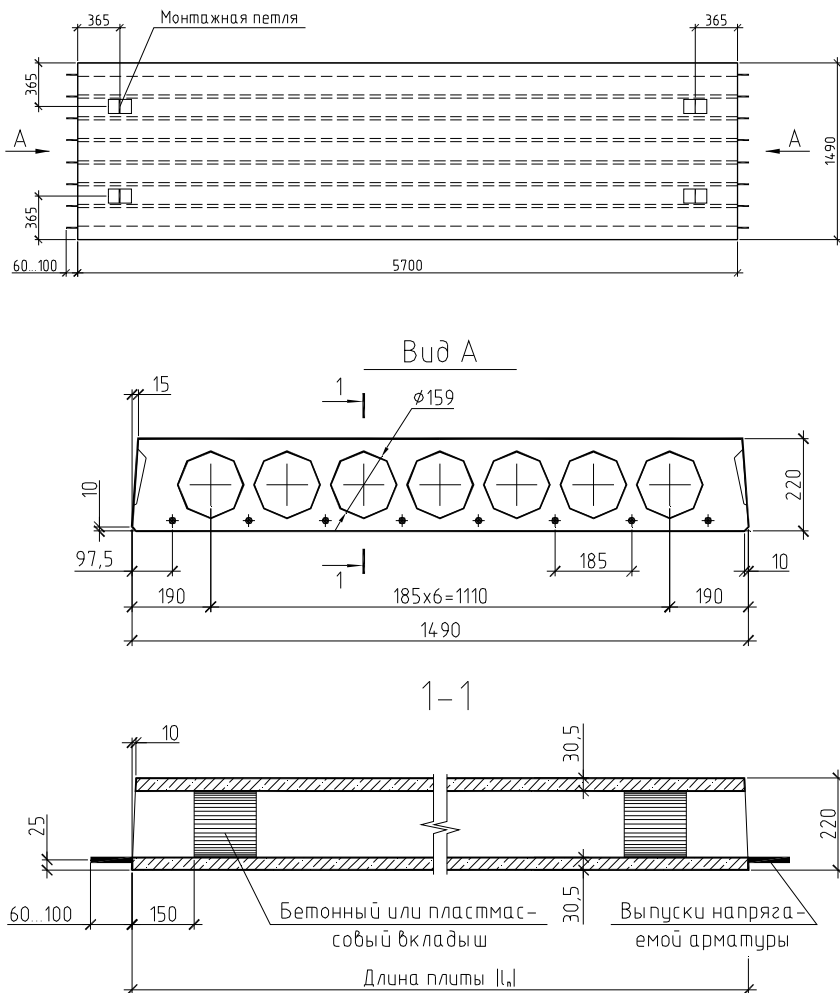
Многупустотная плита перекрытия (размеры условные)
